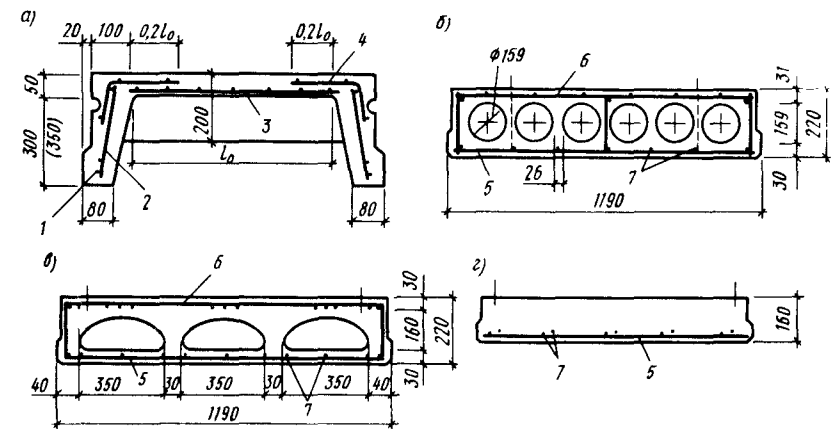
Плиты перекрытий: а — ребристая; б, в — пустотные; г — сплошная; 1 — рабочая напрягаемая арматура; 2 — арматурные каркасы продольных ребер; 3 — арматурная пролетная сетка плиты; 4 — то же, опорная; 5 — нижняя плоская сварная сетка; 6 — то же, верхняя; 7 — продольная рабочая арматура
